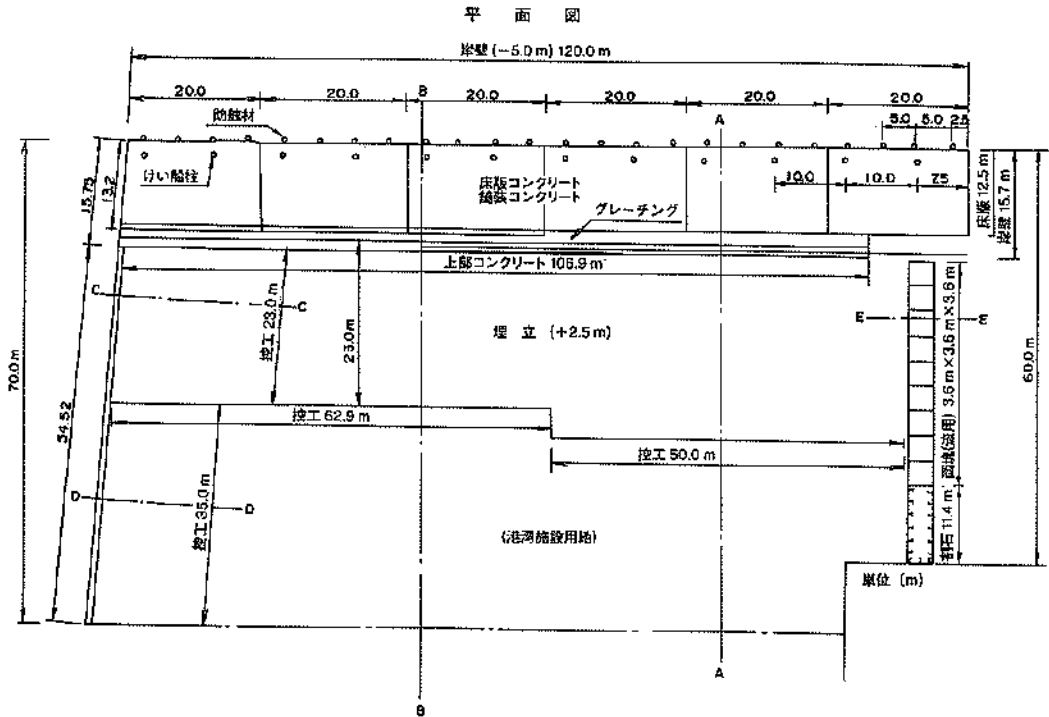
(a) 豊川埠頭岸壁 (旧鋼管杭) 平面図 (函館港)
